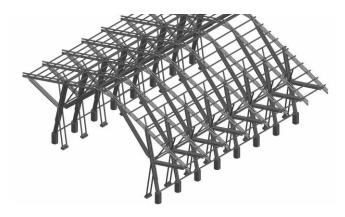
Levantamiento de restaurante en 3D. Software Autocad
